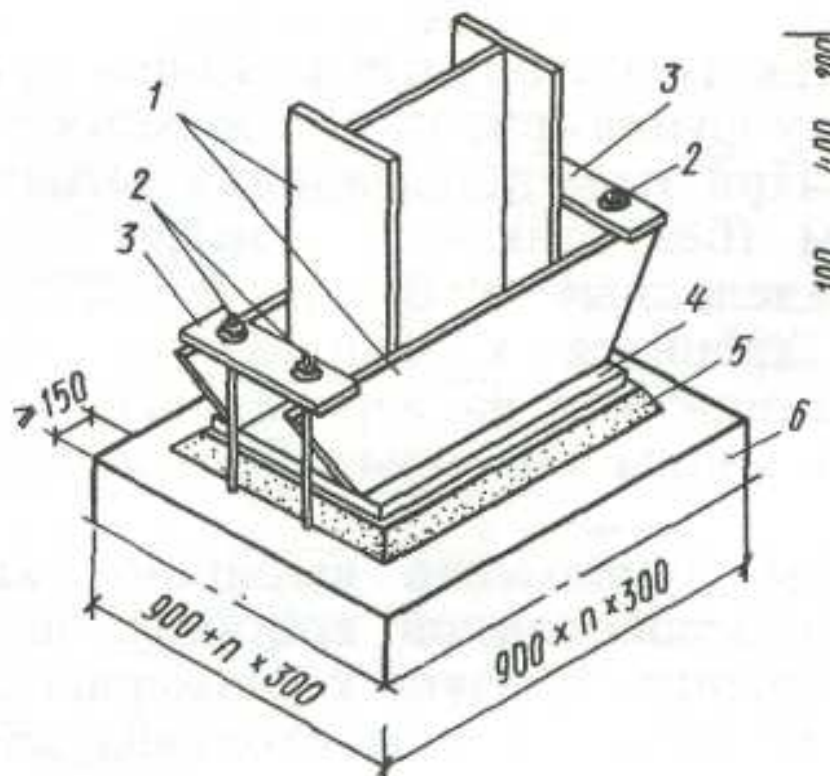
Опираие стальной колонны на фундамент с траверсой [23]:
